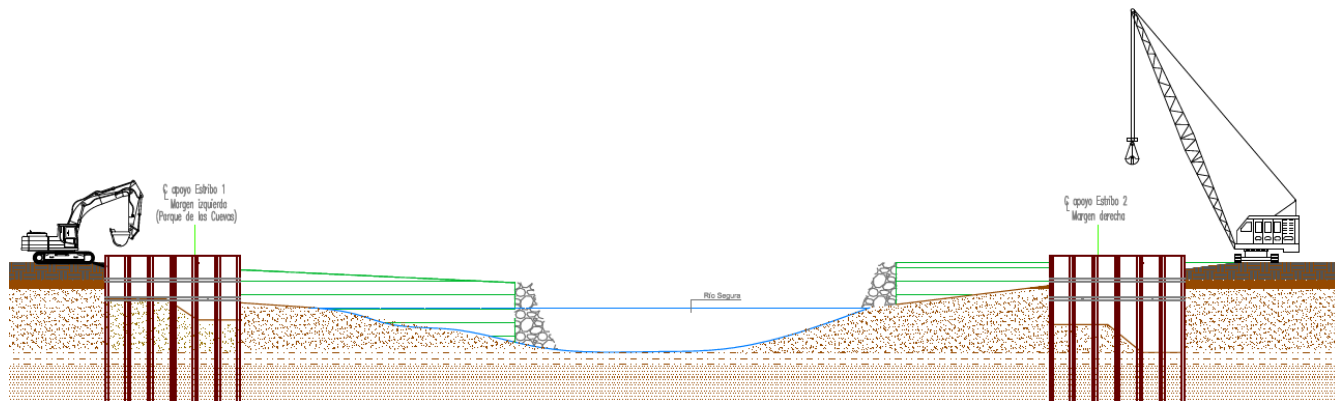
b. Imagen del tablestacado y posterior excavación
